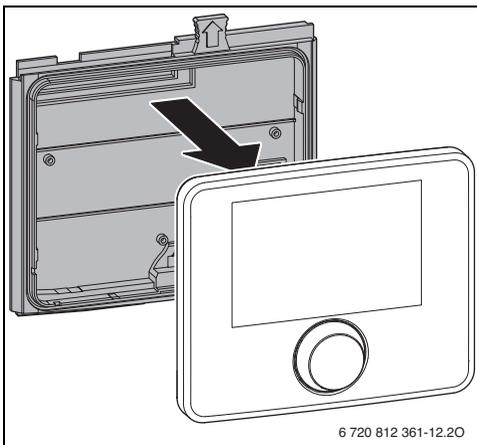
Monter le cadre de montage à l'arrière du module de commande
